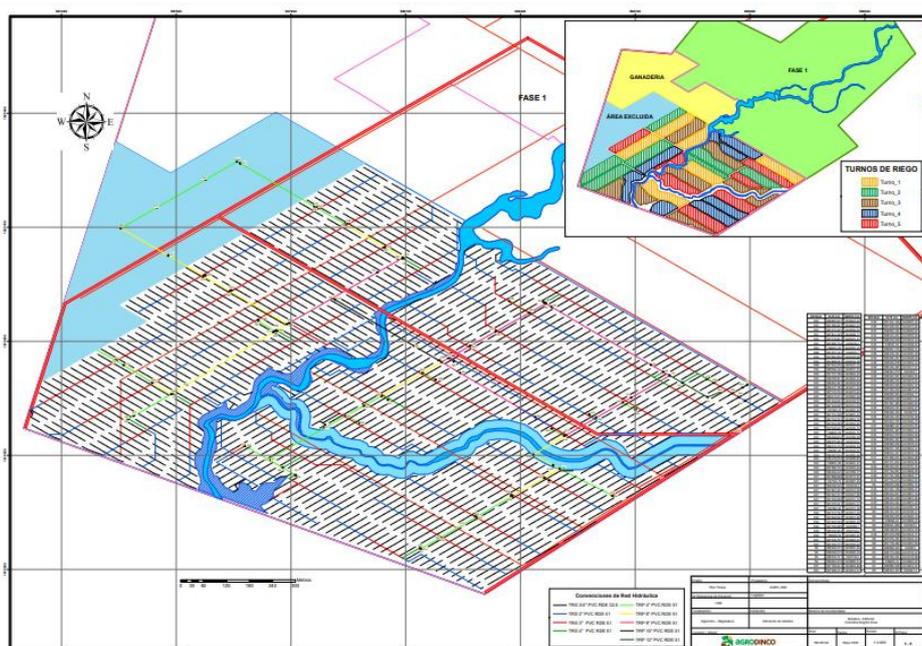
Plano de ubicación de detalles de riego - Proyecto Plan Parejo. Fuente: Agrodinco SAS.
